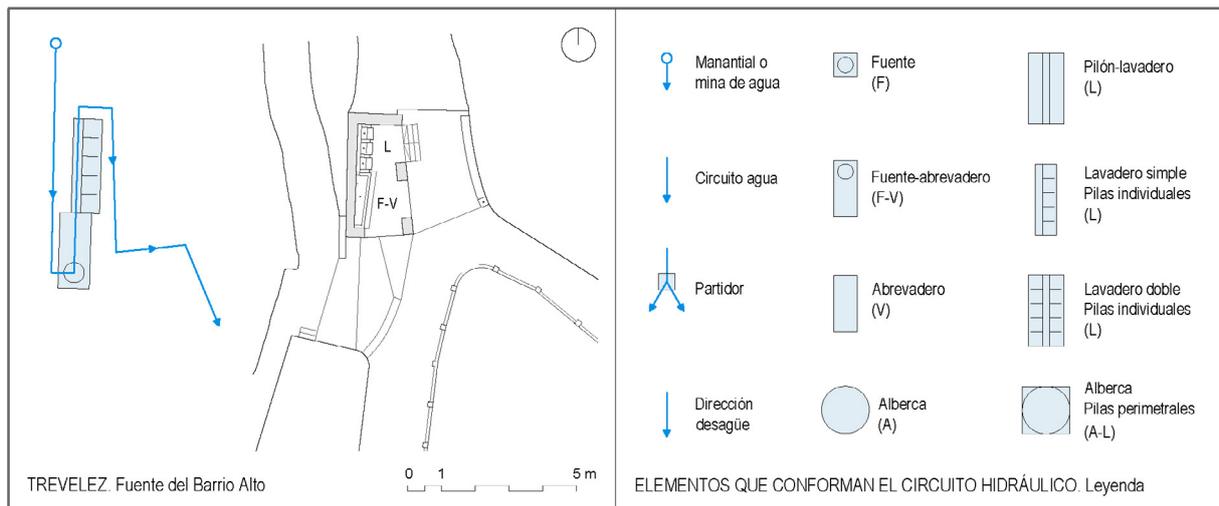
Conjunto hidráulico Tipo 1 (una pieza: fuente-abrevadero-lavadero): Lavadero del Barrio Alto de Trevélez
